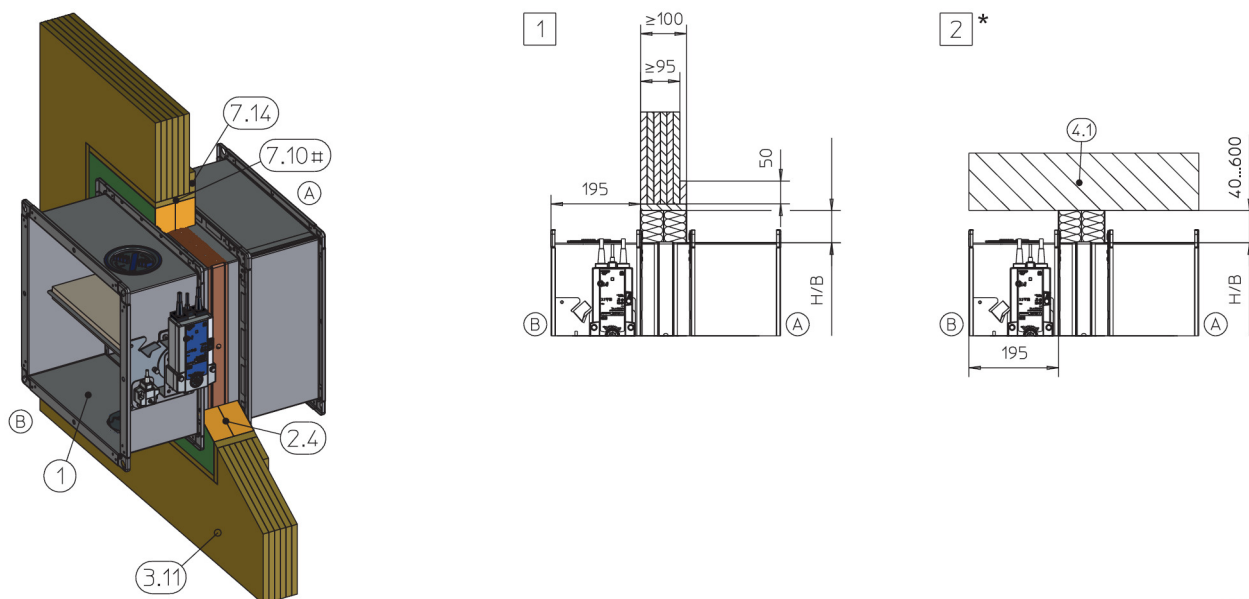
Installazione a secco senza malta in una parete solida in legno o in legno lamellare a strati incrociati, con kit d'installazione ES
